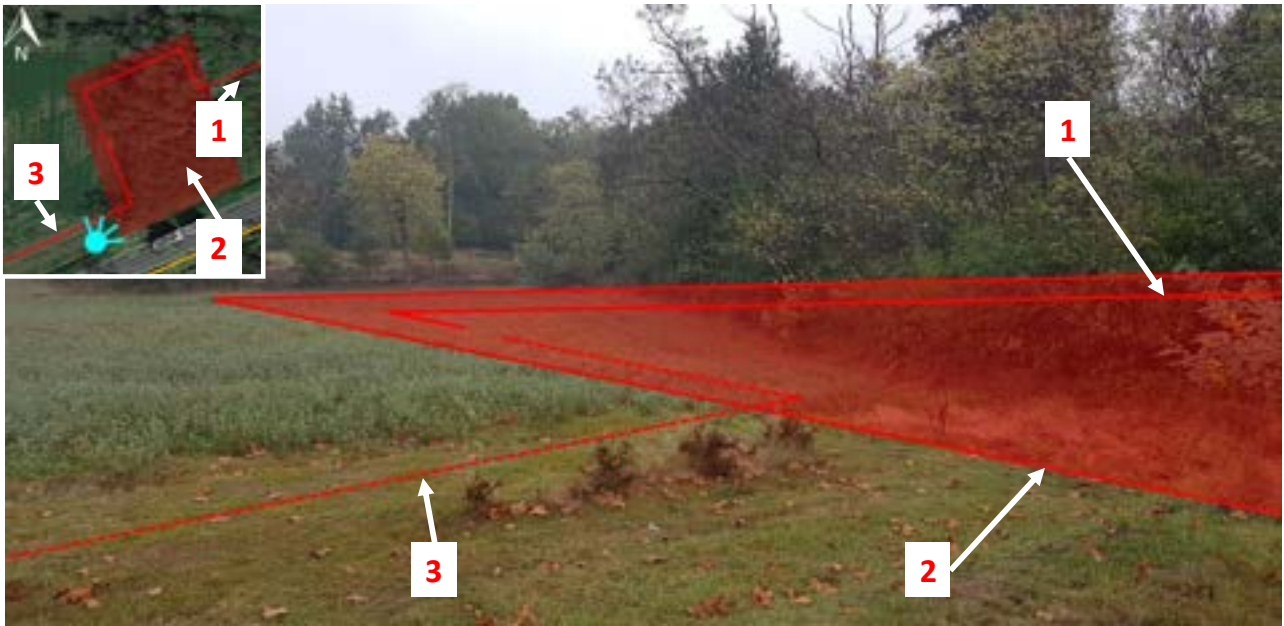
DN80 BRESSOLS – MONTECH GRDF projetée dans la forêt domaniale d'Agre via l'emprunt d'une piste forestière sur environ 900 ml sous protection dalles
